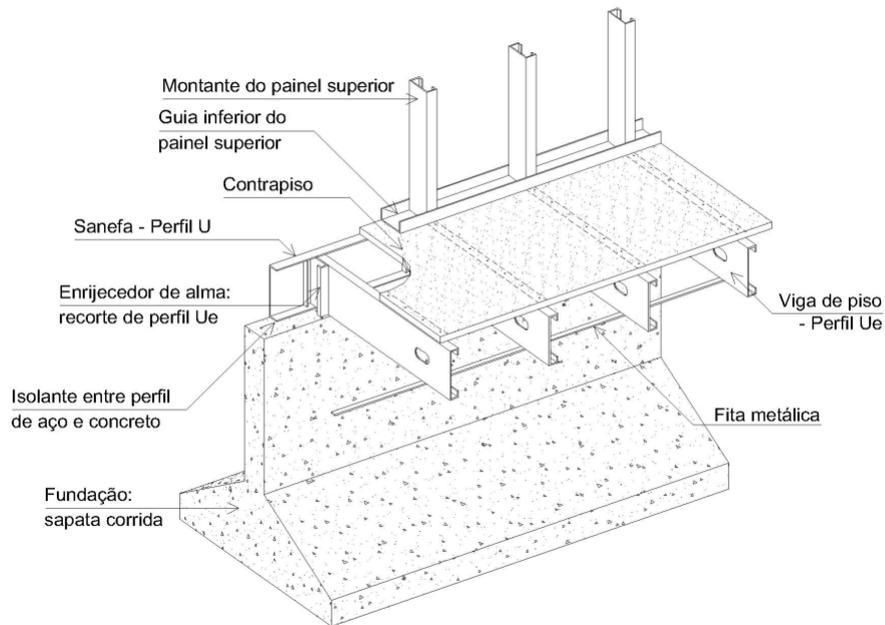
Laje em Steel Framing apoiada sobre fundação tipo sapata corrida
